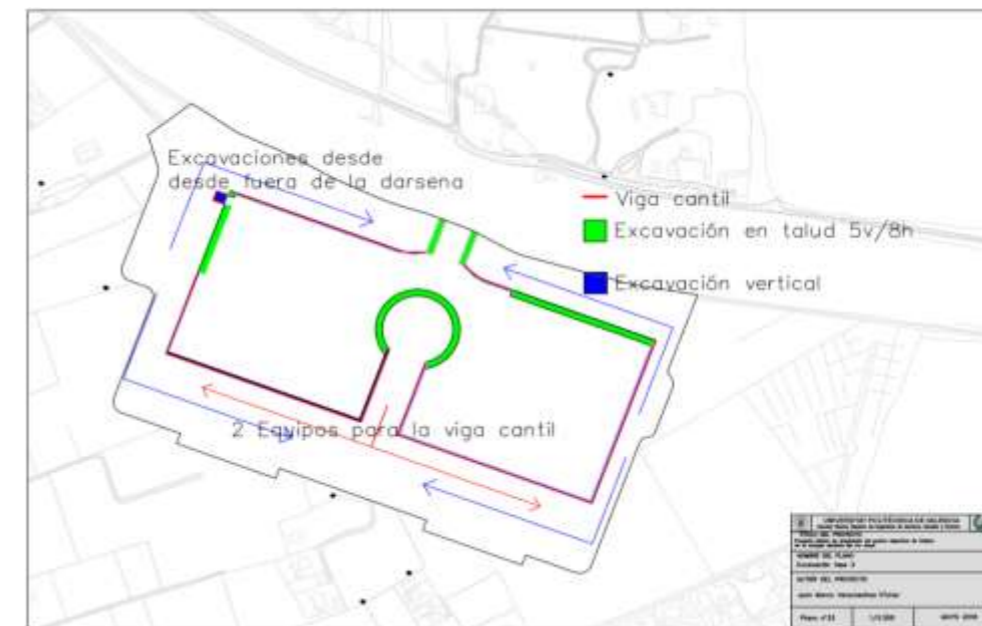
Excavaciones finales y frentes de trabajo de la viga cantil
